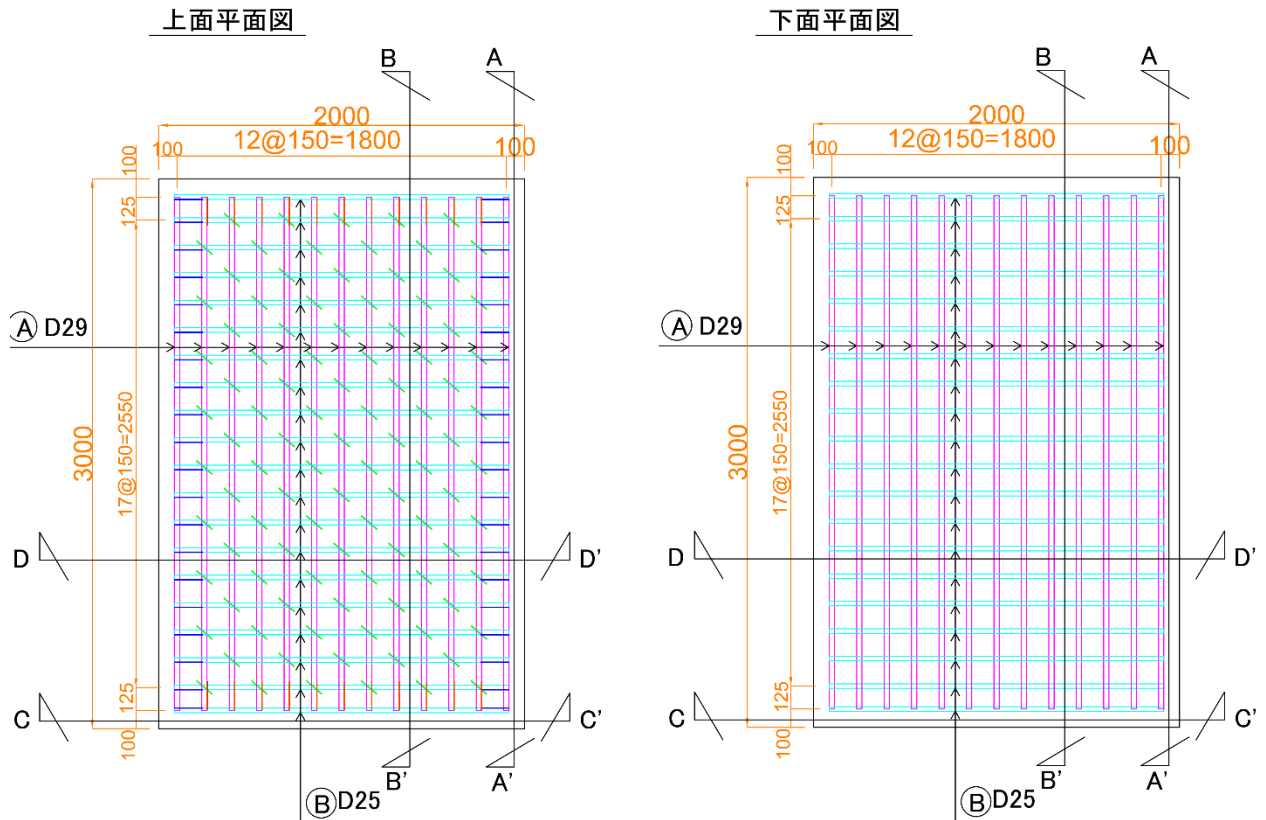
鉄筋コンクリート供試体の配筋図 (平面図)
